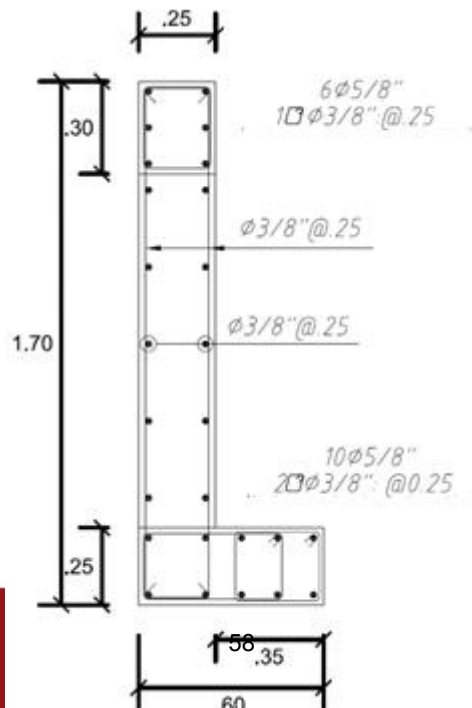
Placa PL10 en el primer piso con refuerzo.
